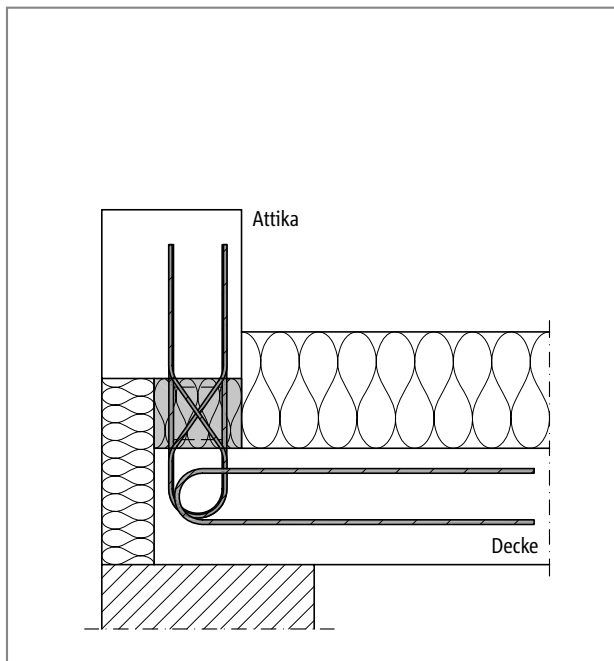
Schöck Isokorb® XT Typ A: Anschluss einer Attika (XT Typ A-MM1)
